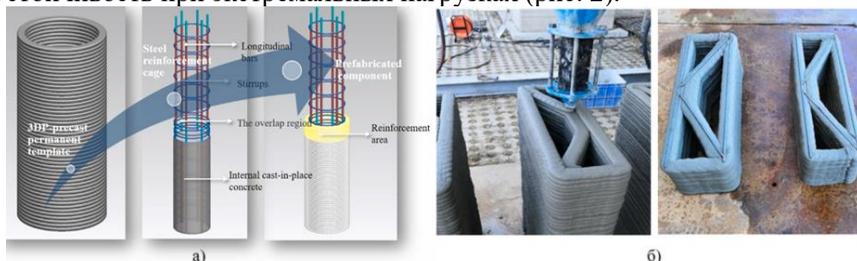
Примеры конструкций, изготовленных методом 3D-печати: а – колонна; б- фрагмент стены
